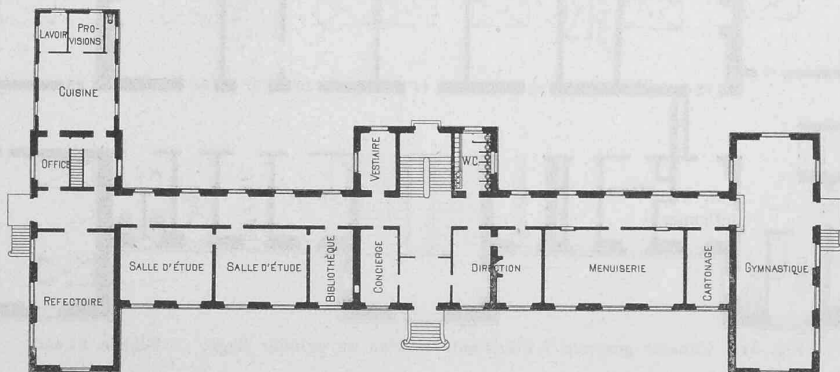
Plan du rez-de-chaussée. — Echelle 1:600.
